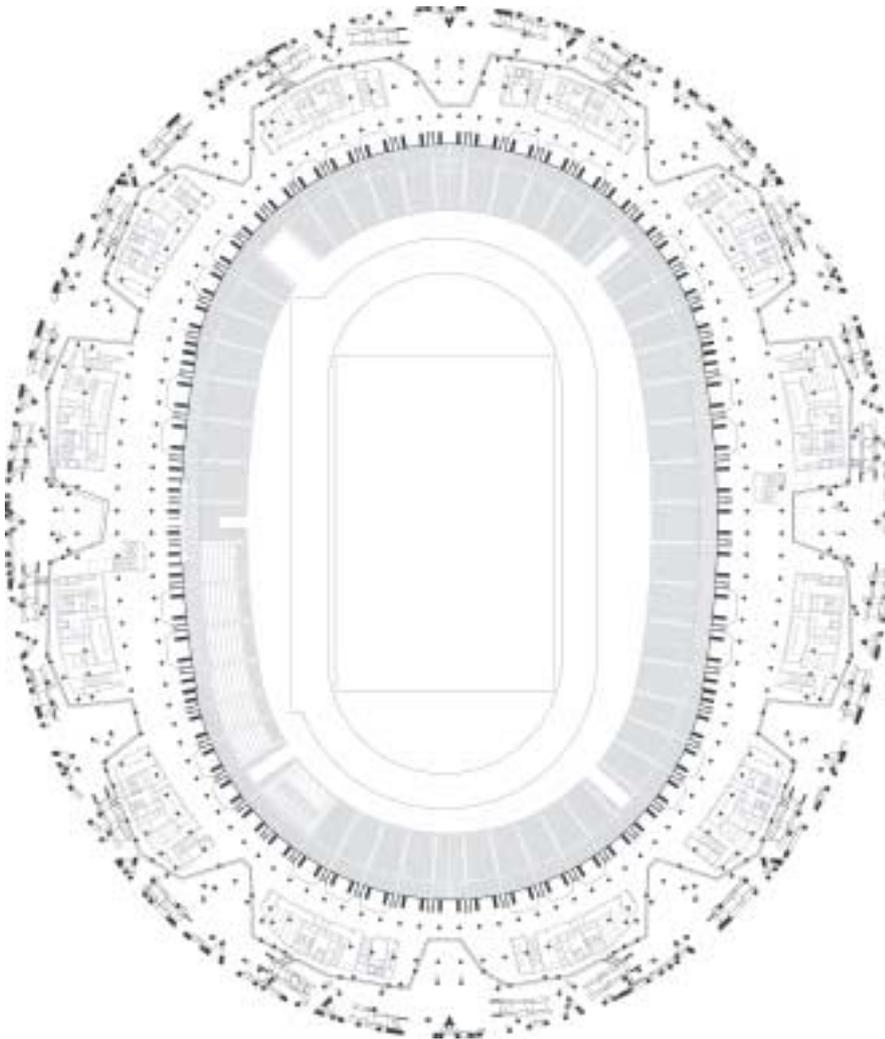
Grundriss der Logenebene (o. M.)
